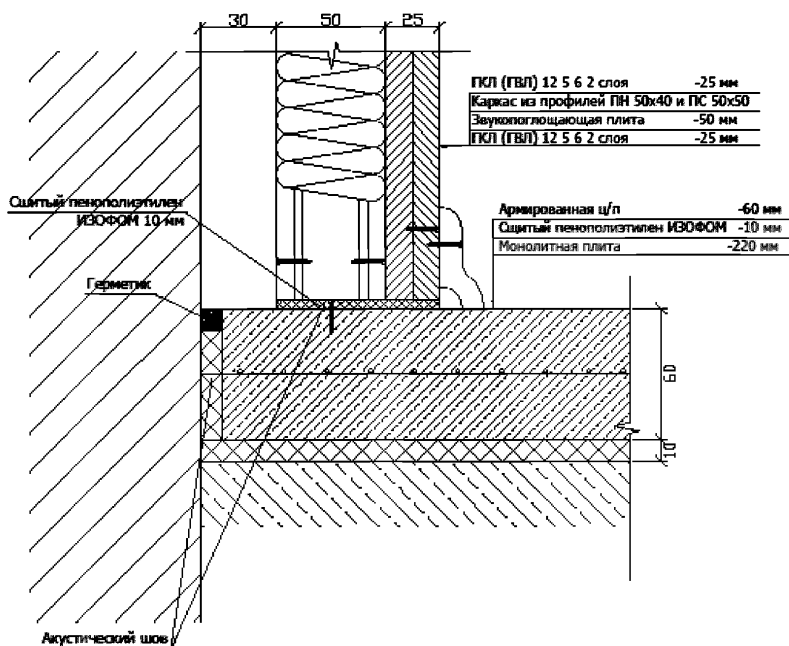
Узел примыкания конструкции плавающего пола к несущим стенам
